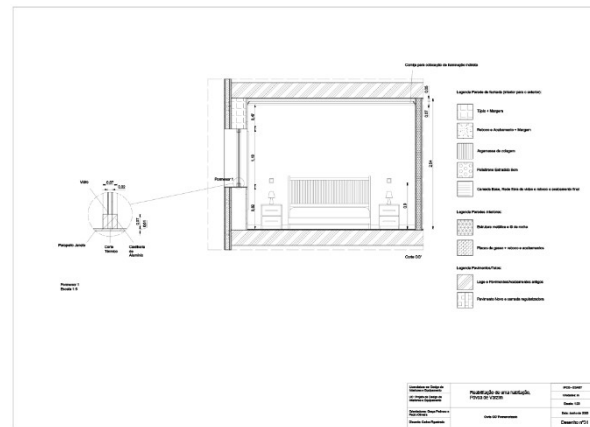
Corte Pormenorizada Habitação Piso 1. Fonte: Autor.
